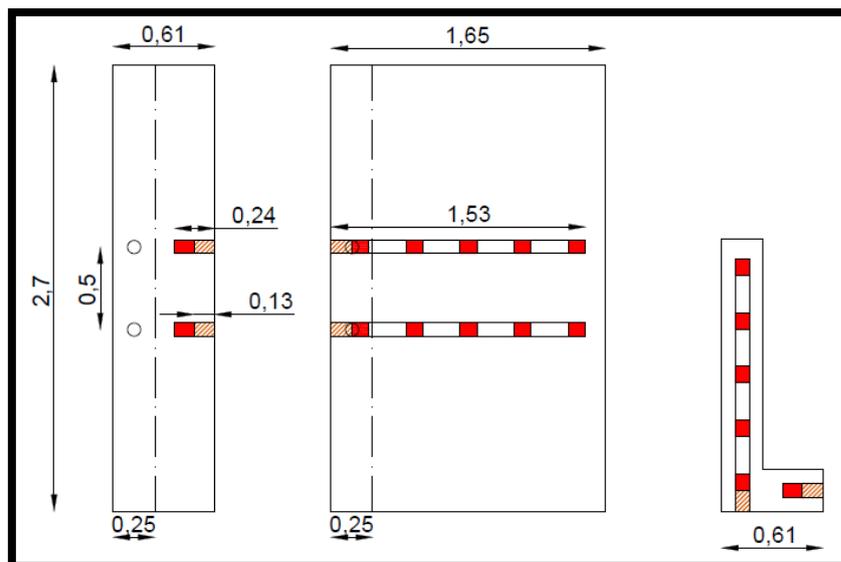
Alzado, perfil y planta del pilar “Hueco del Ascensor” de la primera y cuarta Planta.
